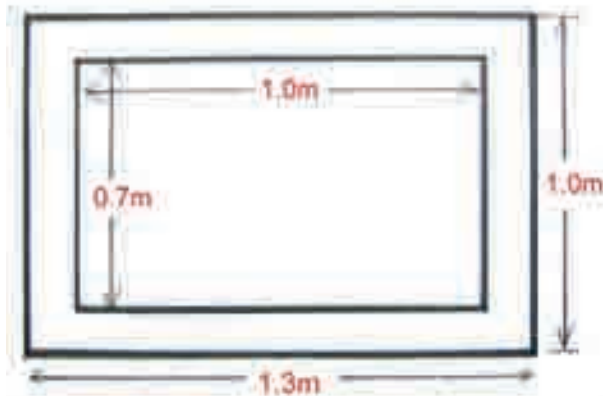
Un moule de dalle fait avec des briques et du bois.
